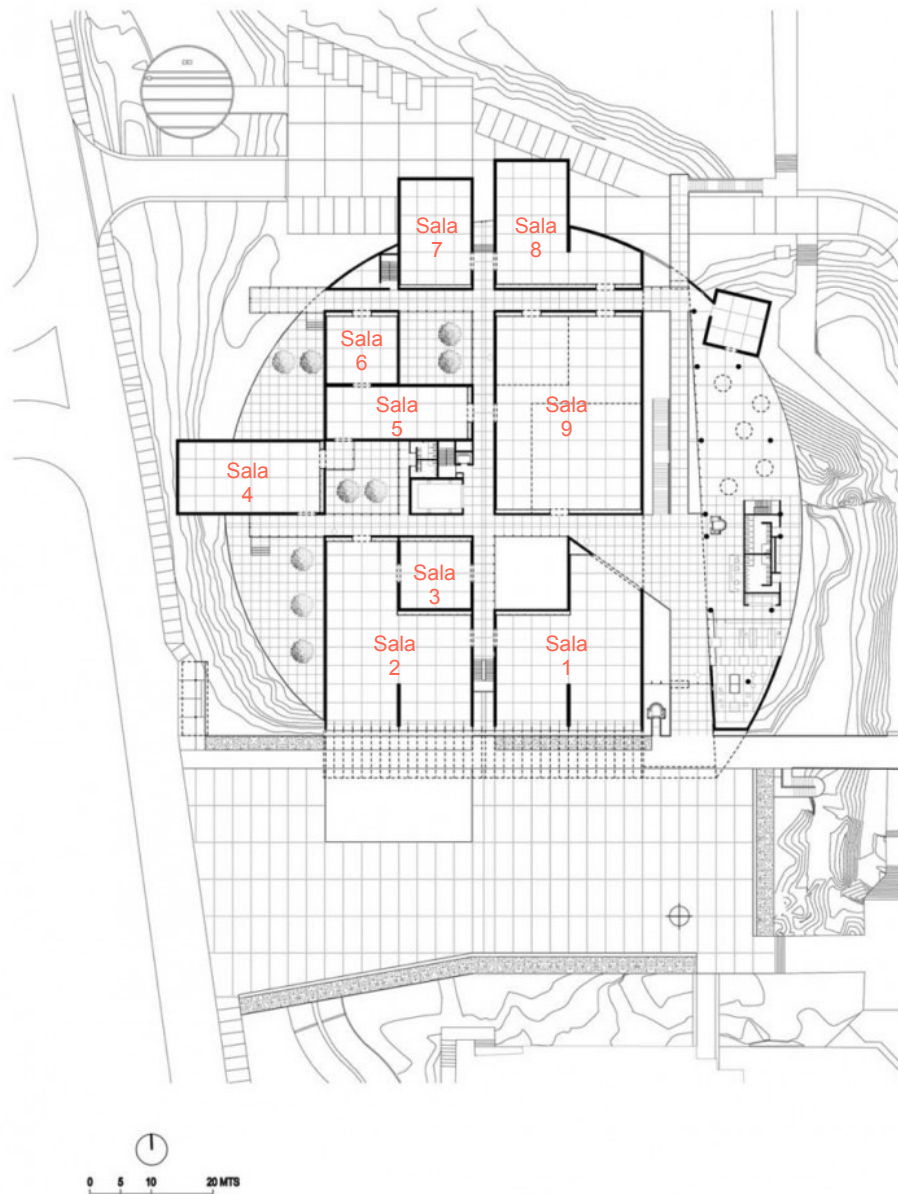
Planta de acceso del Museo Universitario Arte Contemporáneo. Plano original recuperado de: Jesús M. Llamosas. Revisión arquitectónica del MUAC
